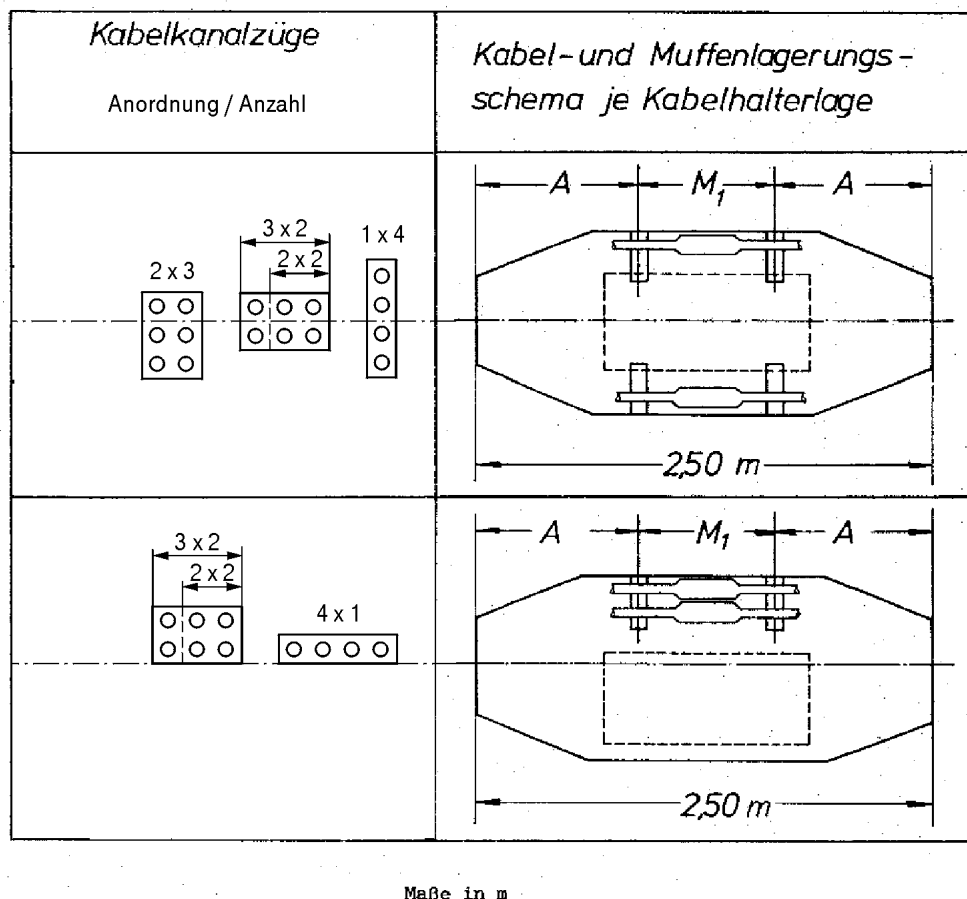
Lagerungsschema für KSch 2,5 m lang
